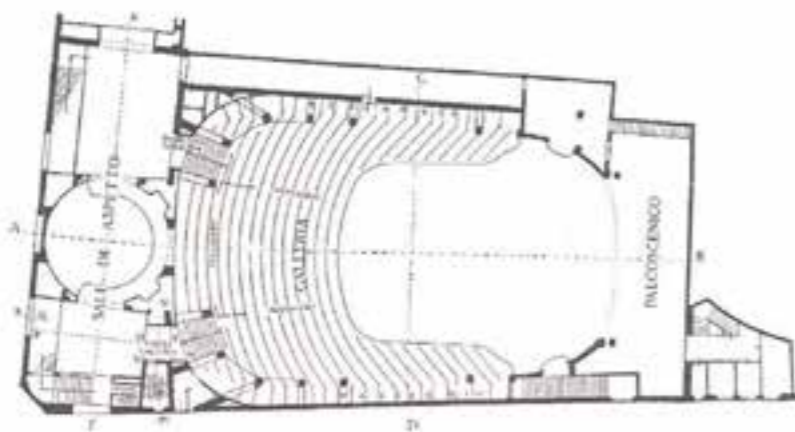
Esempio di pianta a ferro di cavallo, Cinema Barberini di Roma arch. M. Piacentini, pianta galleria
